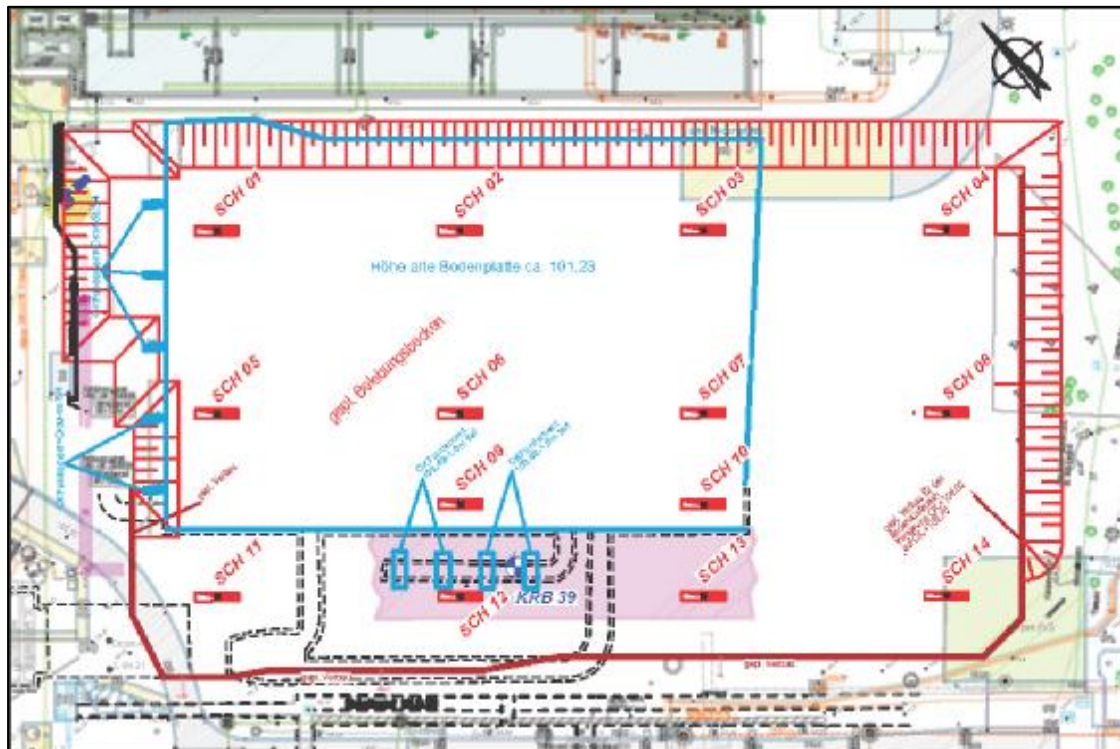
Lageplan mit Darstellung der geplanten Baggerschürfe – Belebungsbecken E
